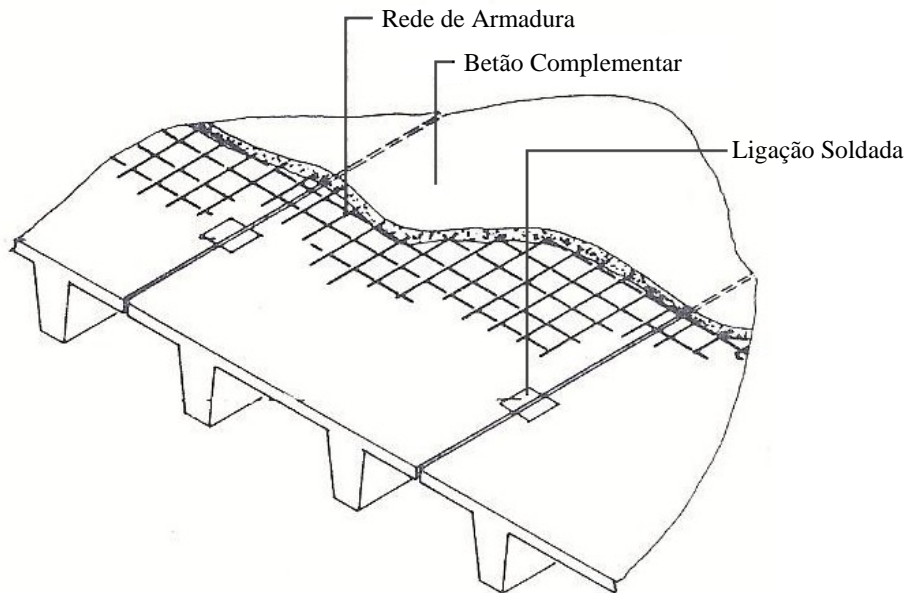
Ligação laje - laje por soldadura de chapas metálicas e posterior betonagem da lâmina superior, adaptado de [6]
